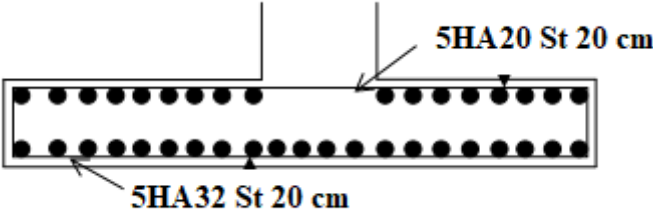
Schéma de ferrailage de la semelle sous
